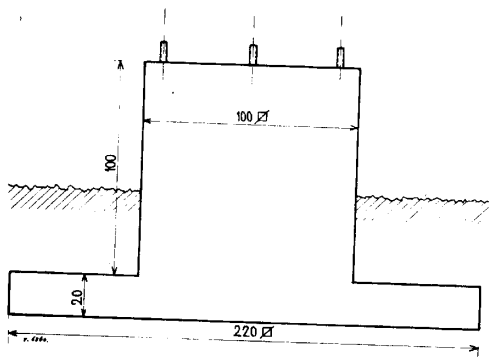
Deze fundatie werd ontworpen voor de antennemast van PAoSE. Het totale gewicht bedraagt ongeveer 4,25 ton. De aarde boven de grondplaat naast de centrale kolom draagt door zijn gewicht ook nog bij tot de stabiliteit. In de beton is een bevestiging opgenomen. Van het ingegoten „kader” steken de drie draadeinden boven het blok uit. In verband met de hoge grondwaterstand is het blok niet dieper dan 60 cm ingegraven.
